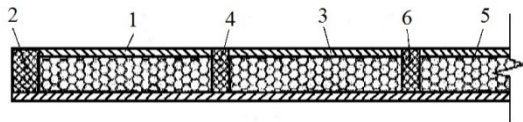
Схема бетонирования верхней части перекрытия: 1-6 – порядок бетонирования
